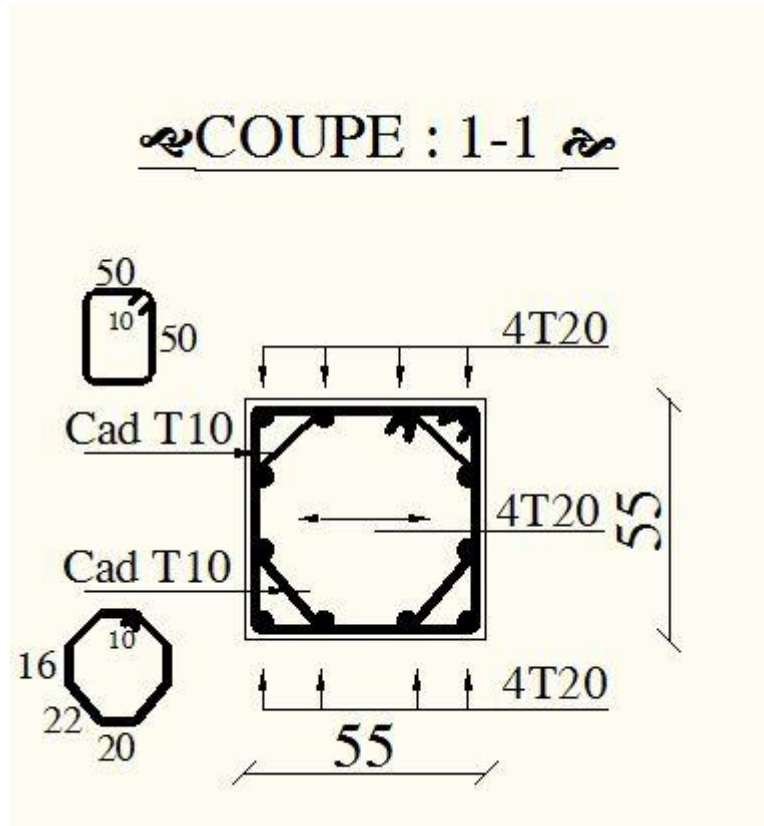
Schéma de la coupe de ferrailage de poteau.
